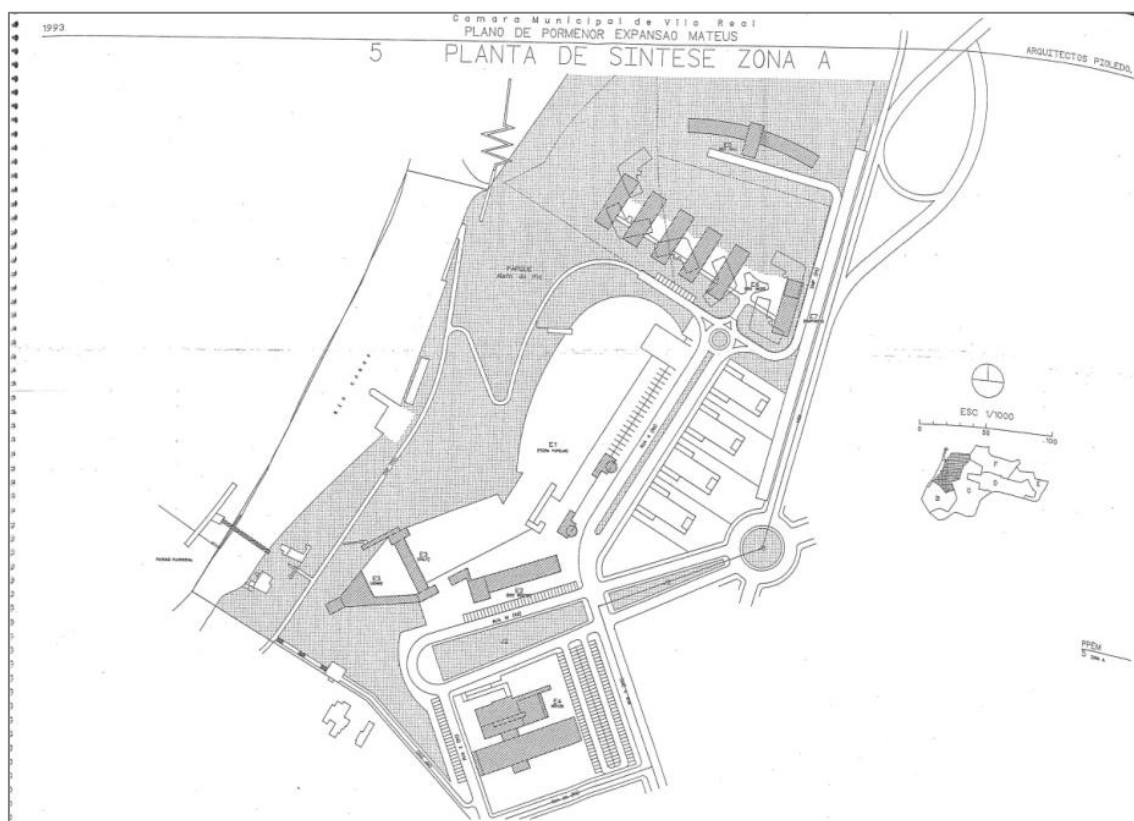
Planta de Síntese Zona A da Proposta de Plano do PPEM (1993)
